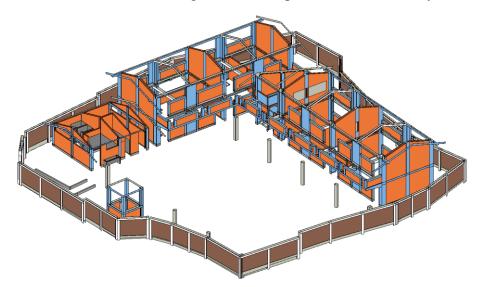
Categoría Muros aislado del modelo federado de Arquitectura
